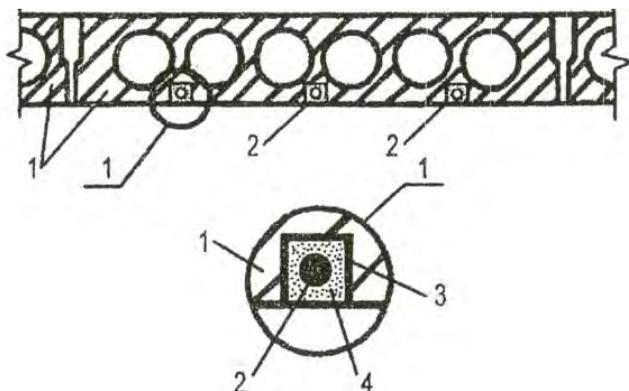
Усиление плиты перекрытия установкой дополнительной арматуры на растворе:
